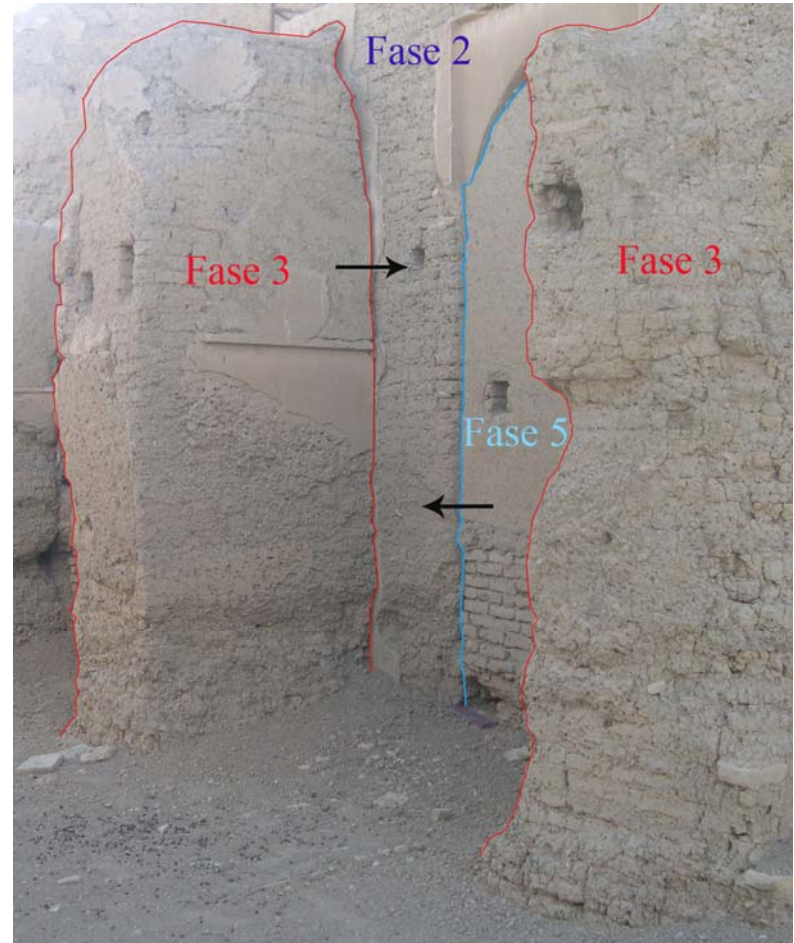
Masjed-e Jāme^c di Haftshuye: *gonbadkhāne*, prospetto E, evidenze pilastri dello shabestān S-E (foto dell'autore. Settembre 2008)
